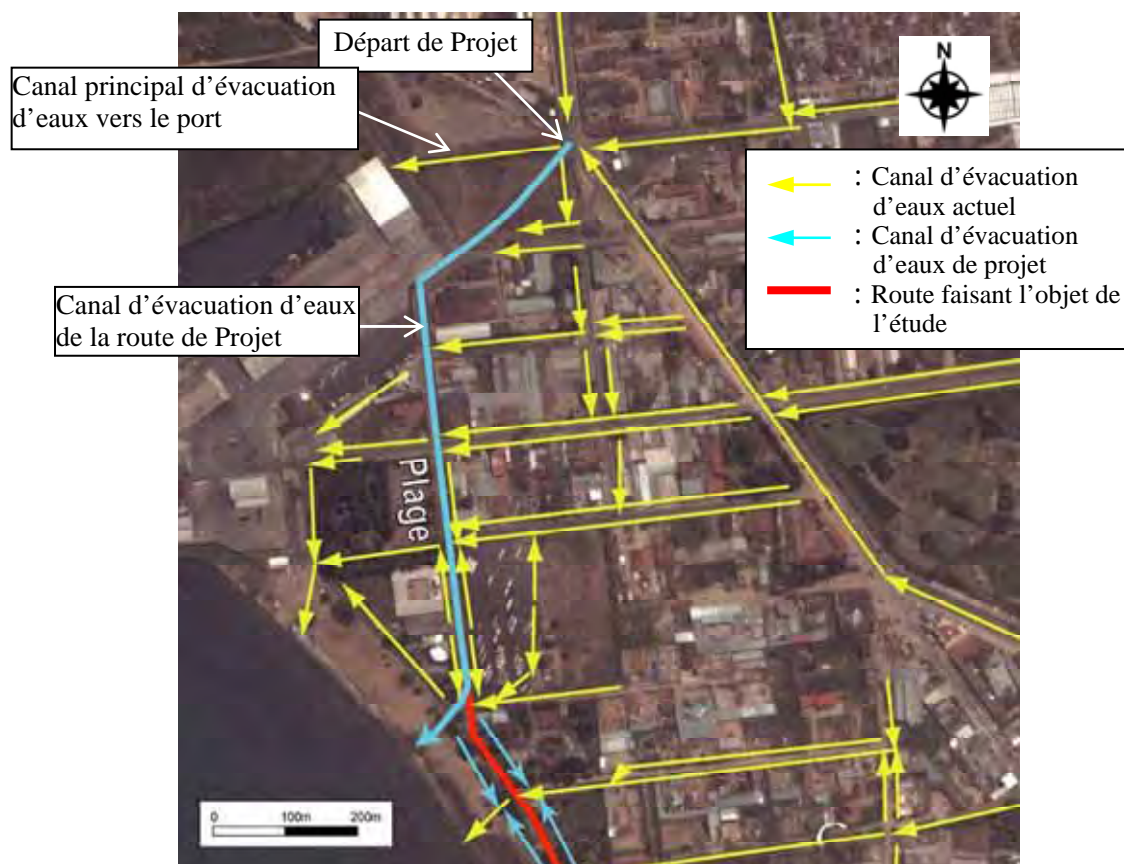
Plan d'évacuation pour atténuer les dégâts d'inondation au point de départ
